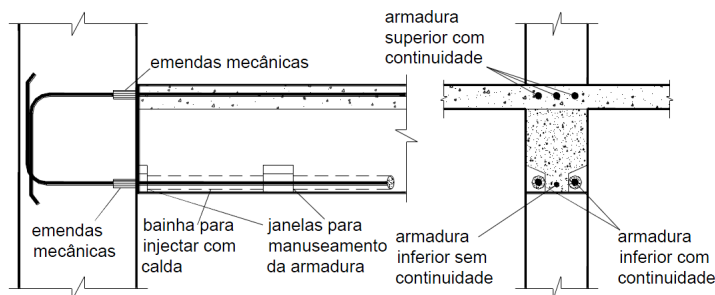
Ligação viga-pilar ensaiada por Reis (2000): solução em viga retângular com betonagem complementar
